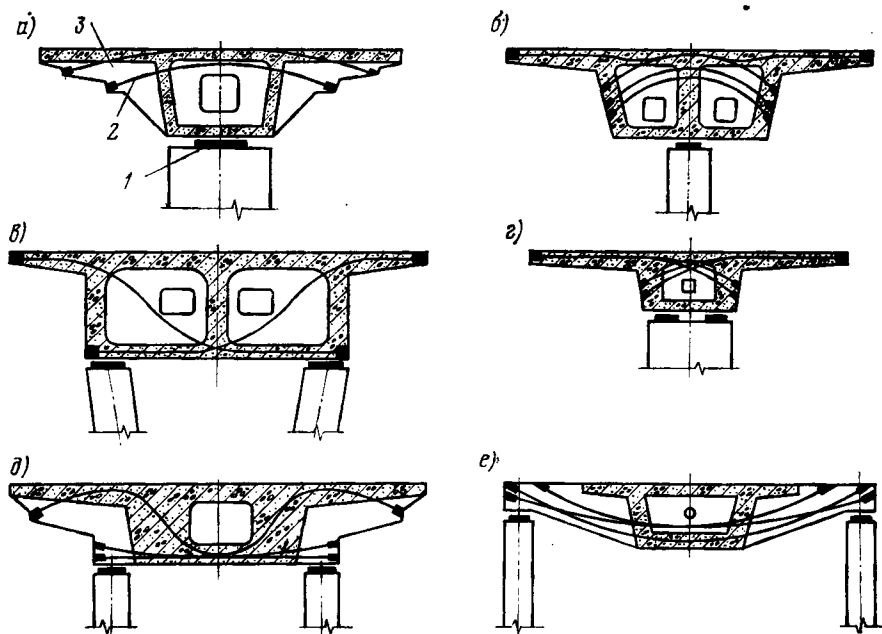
Схема армирования опорных диафрагм напрягаемой арматурой:
